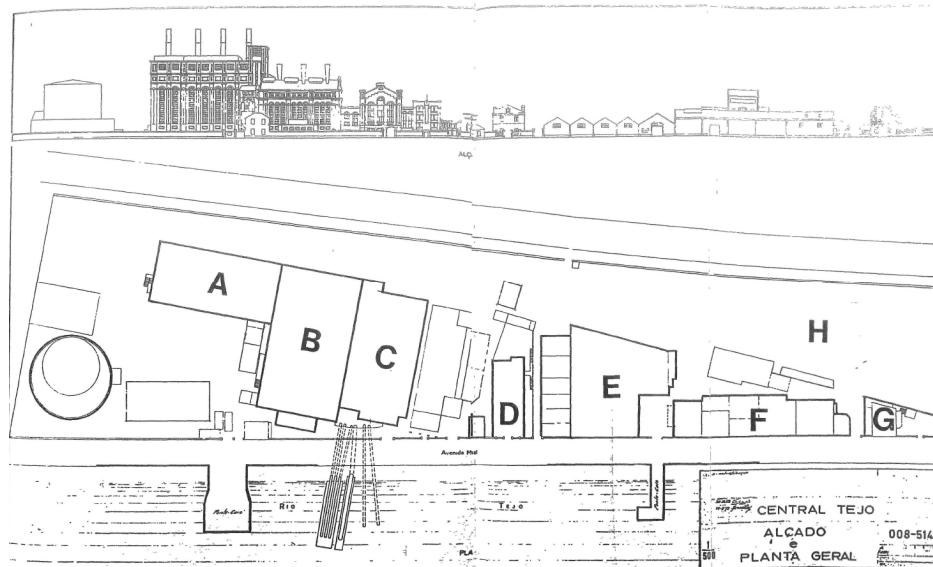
Planta com distribuição dos espaços (Alçada e planta geral). FEDP. Coleção CRGE, Central Tejo. 1985.
